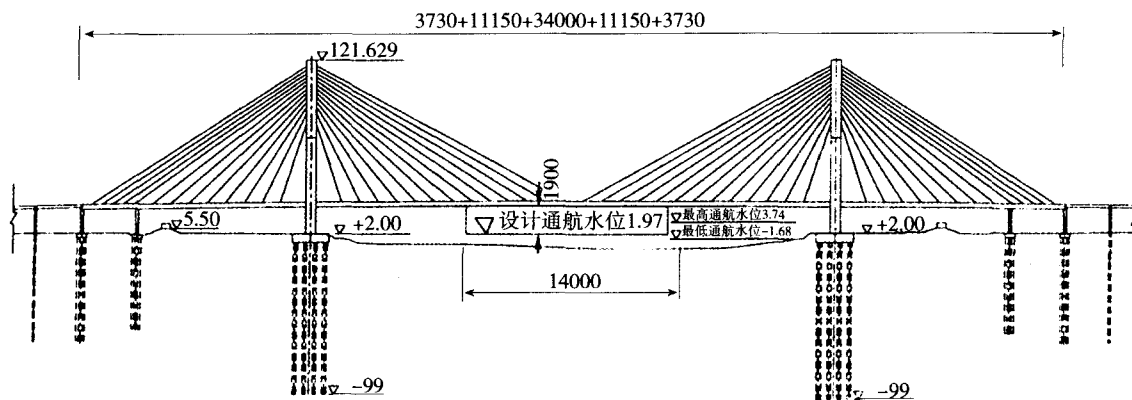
灌河大桥桥跨布置图(尺寸单位:cm)
